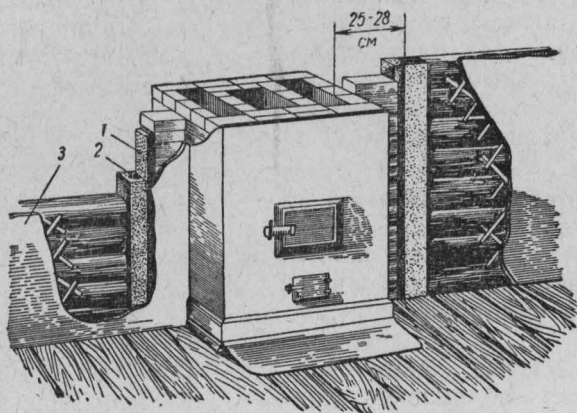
Устройство вертикальной разделки, установленной в проеме деревянной стены (перегородки):
